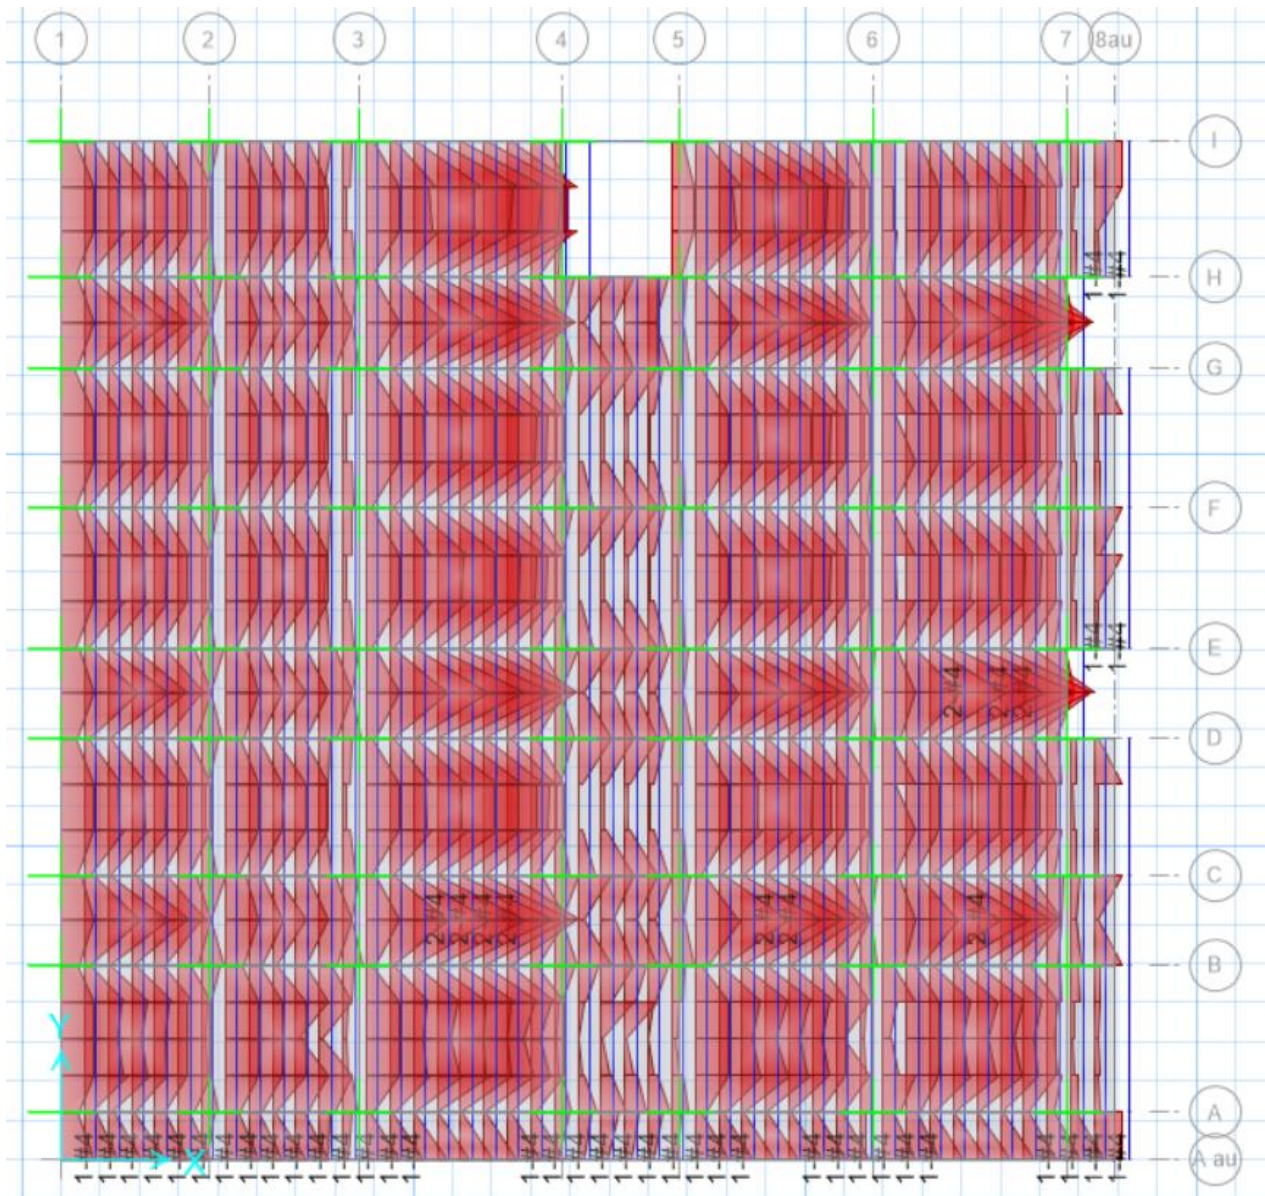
Refuerzo longitudinal para viguetas de losa de entrepiso nivel 3. Tomado de SAFE 2016.
